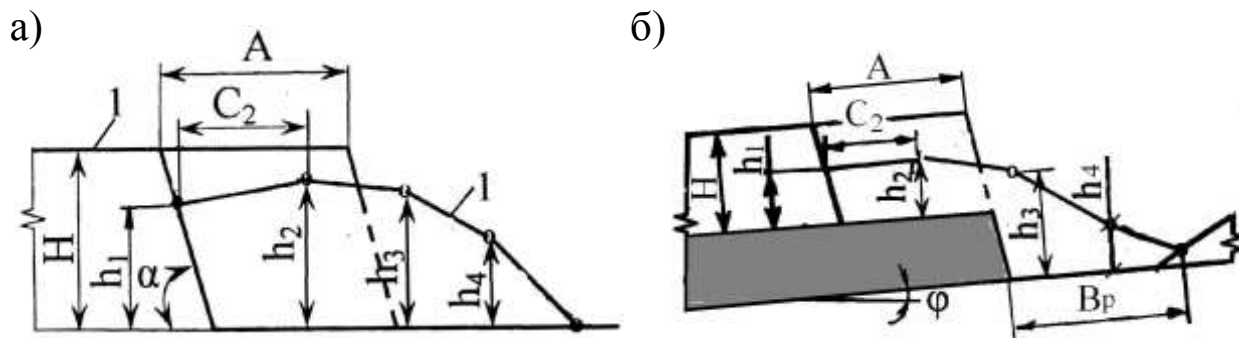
Изображение развала в профиле чертежа: а – транспортного уступа; б – бестранспортного [8].
